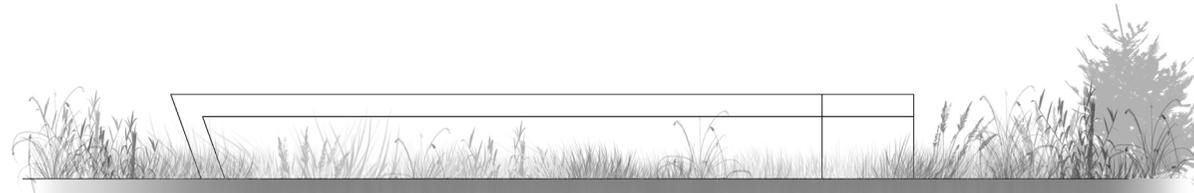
Banco doblado con 2 pilares – alzado , sección
